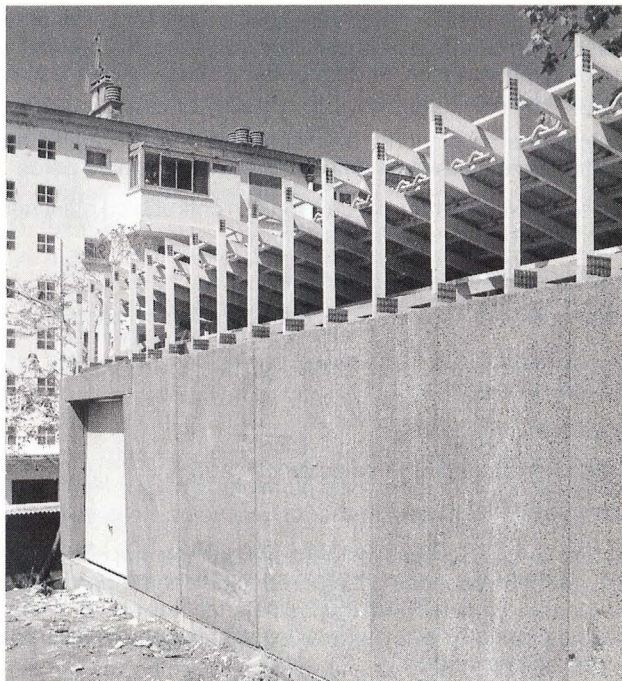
Façade de bâtiment en panneaux de béton de bois (Agresta)
